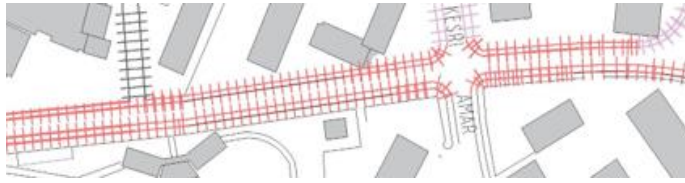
Vue en plan sur la rue BOULILA. Source : auteurs
